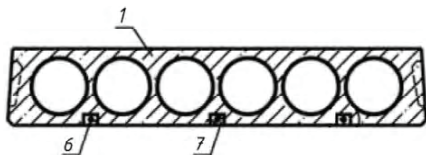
Установка дополнительных арматурных стержней в пазах на полимеррастворе: 1 – усиливаемая плита; 6 – дополнительный арматурный стержень; 7 – полимерраствор.
